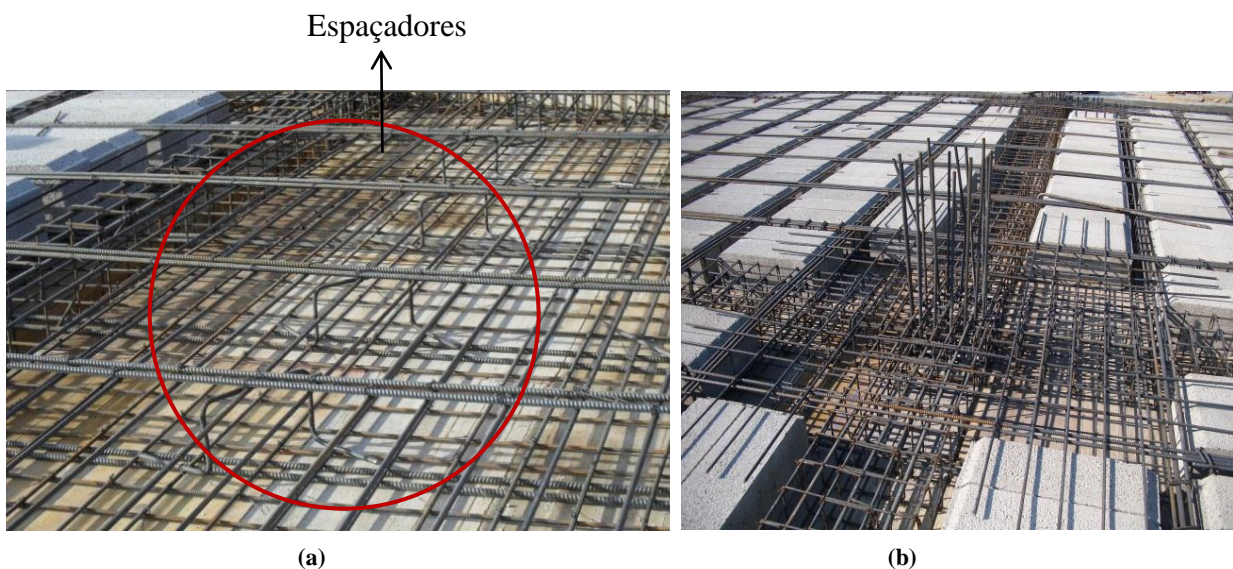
Colocação de espaçadores (a) e armadura da laje com reforço de armadura junto ao pilar (b)
